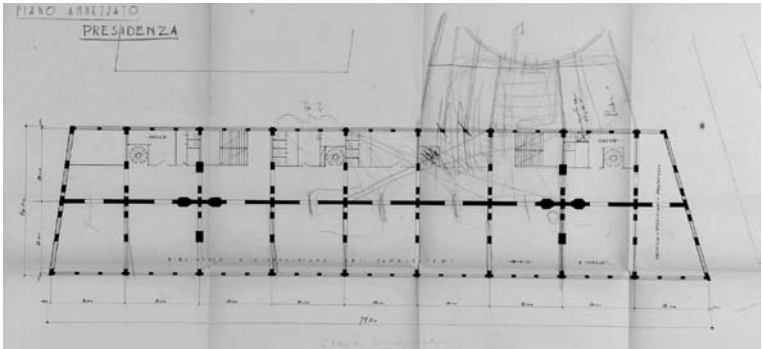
Früher Grundriss des 2. Obergeschosses der Giunta. Gut sichtbar ist die Spina.
